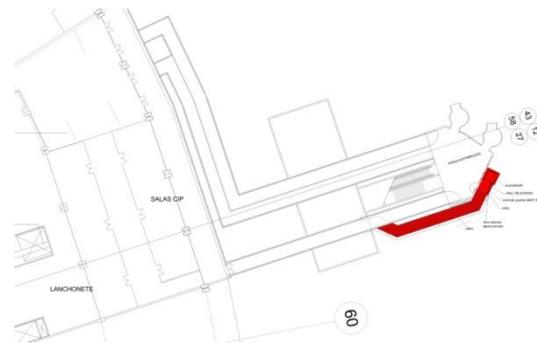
Planta de estudo para a instalação de um elevador, garantindo a acessibilidade.
